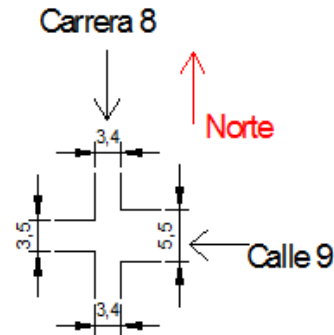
Esquema en planta del punto de estudio cruce carrera 8 y calle 9
